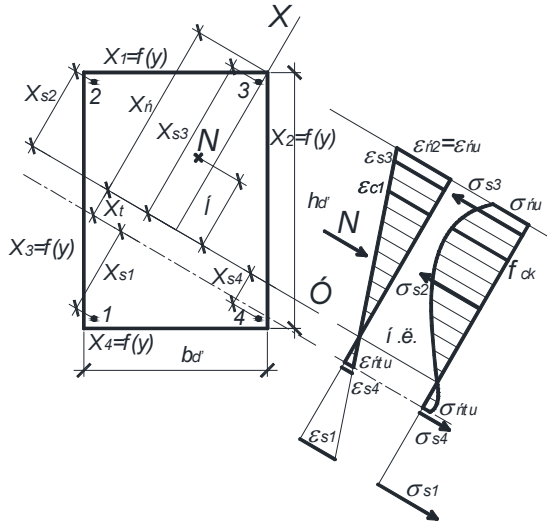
Напряженно-деформированное состояние сечения кососжатого железобетонного элемента
